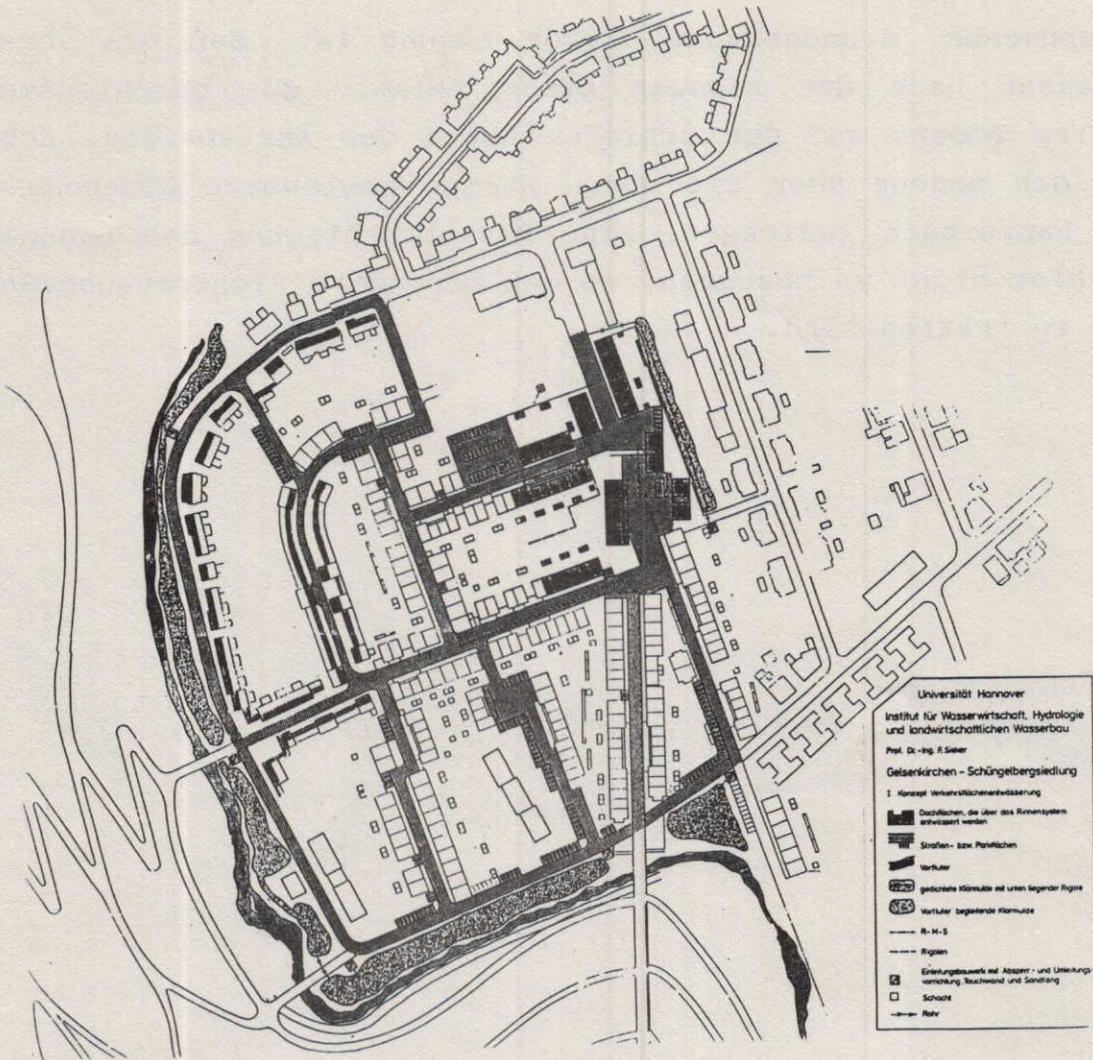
Lageplan der an das Flachnetz angeschlossenen Flächen
